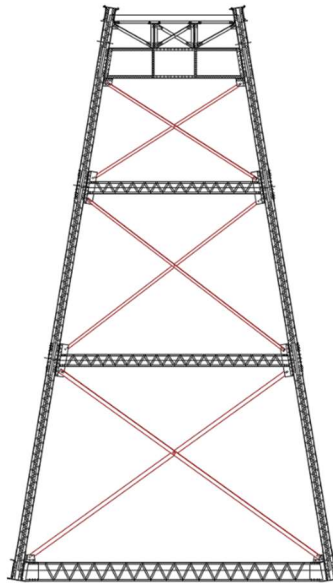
Elementos diagonales al interior de las secciones transversales del puente.
